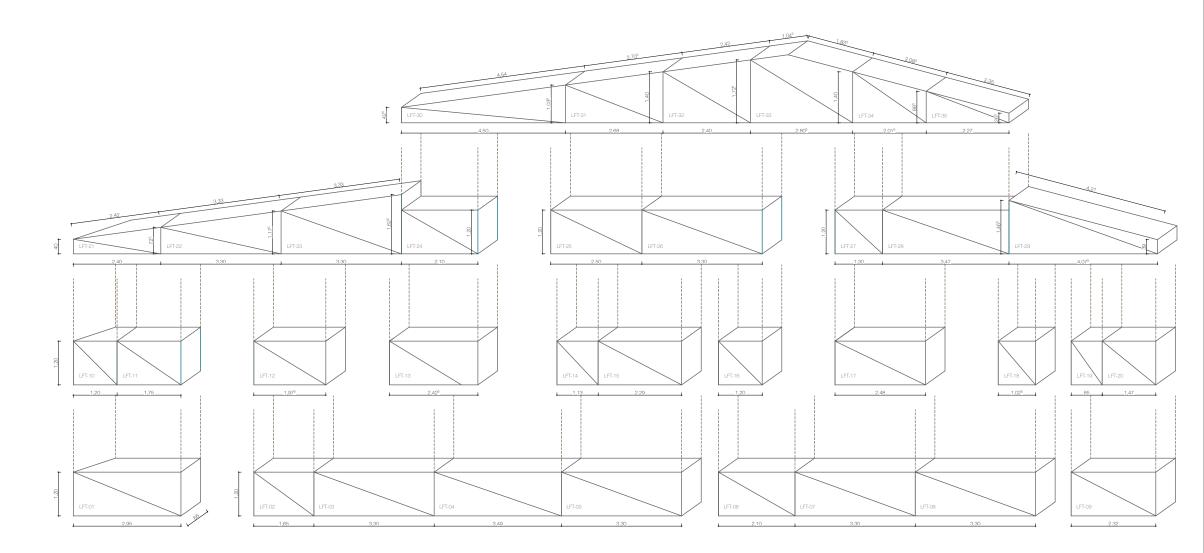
Elementierung Beispiel-Fassade Gruppenhaus
